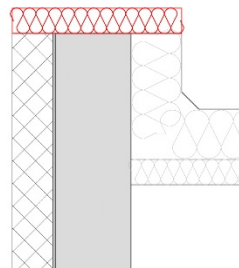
plint knoop 2 ter hoogte van de overgang van sokkel naar fundering in opbouw 1A (cellenbeton met buitenisolatie in sandwichpanelen)
